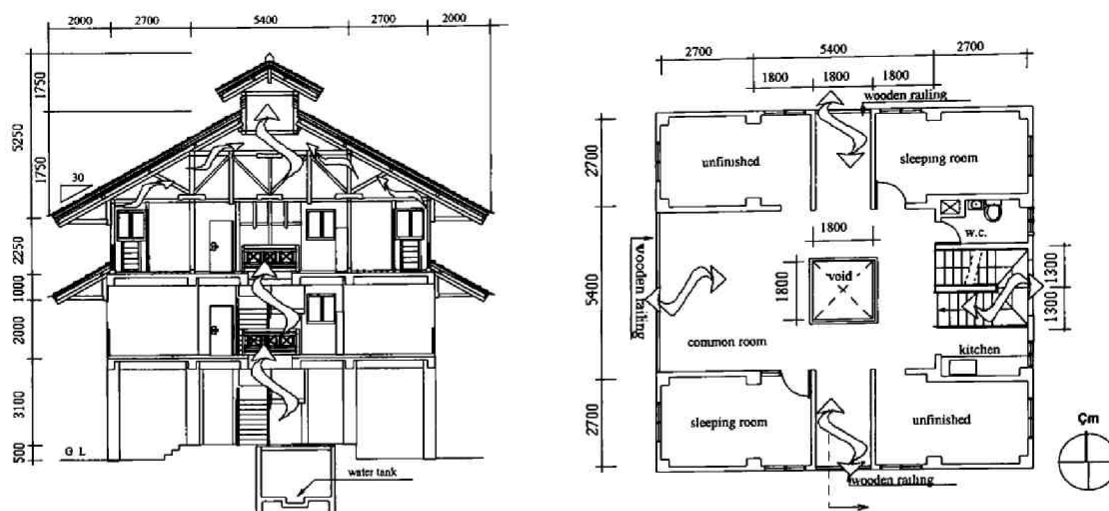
(左) 南北方向への建物中央断面図 (右) 2 階平面図
